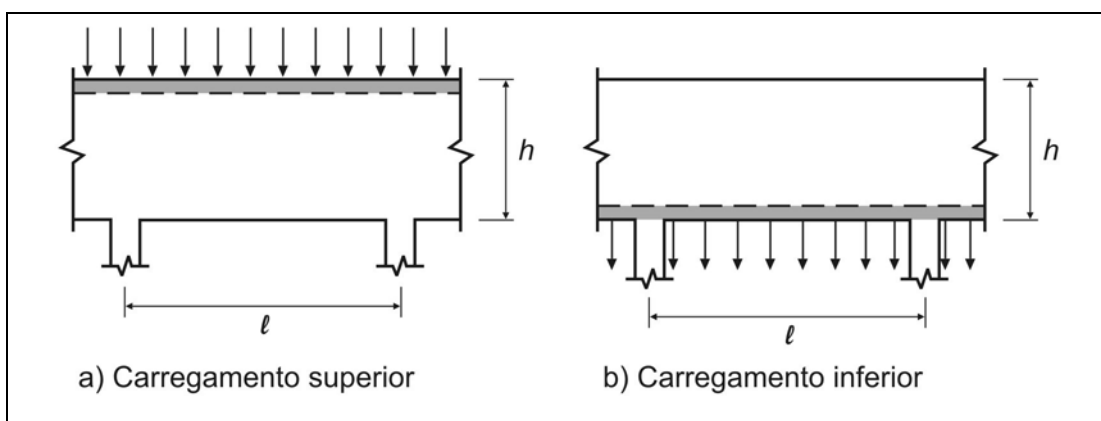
Dois tipos comuns de viga-parede em relação ao carregamento
